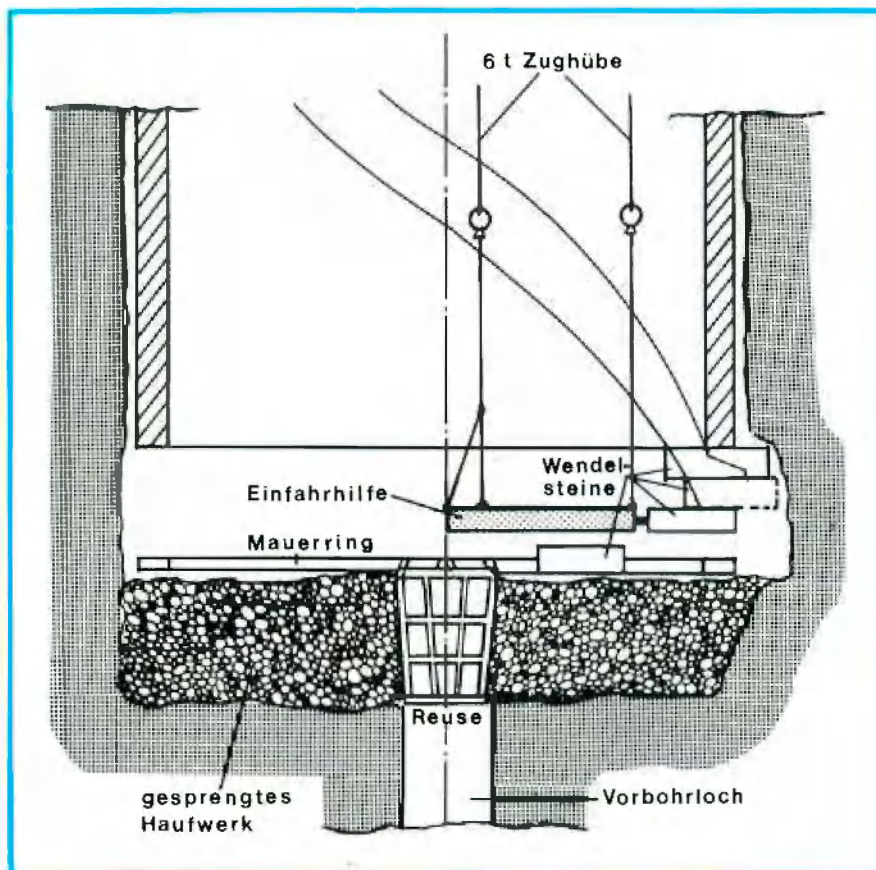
Situation beim Wendelsteineinbau auf dem gesprengten Haufwerk
